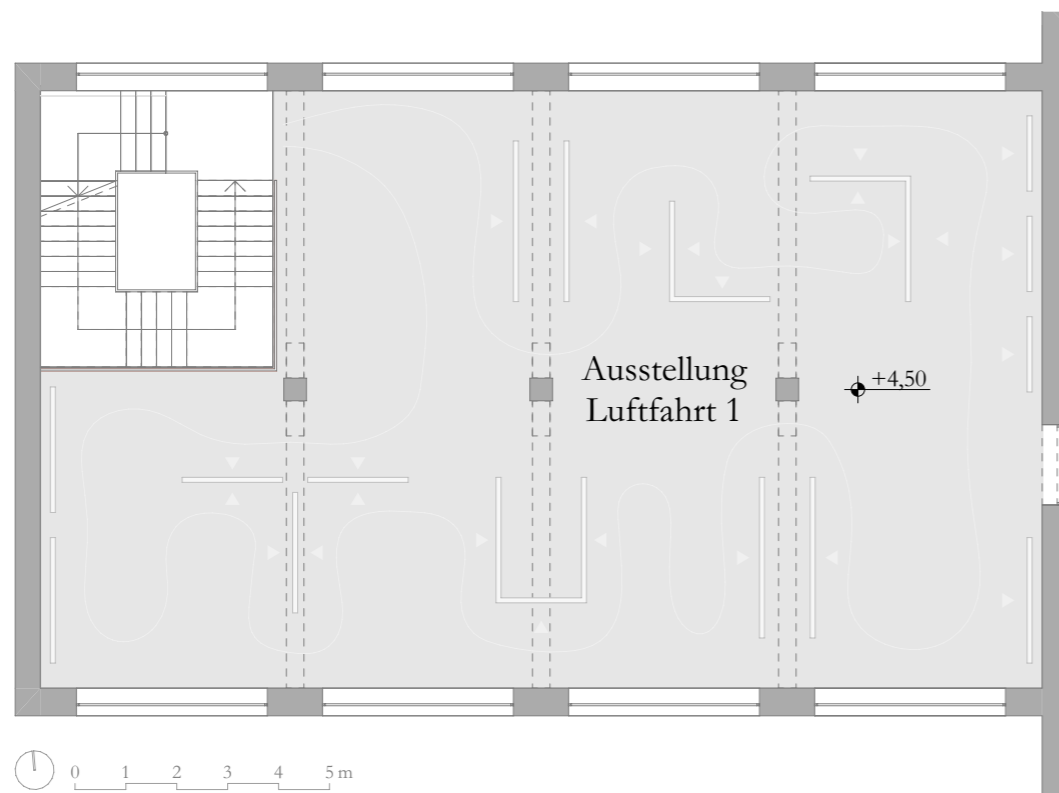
Grundriss Obergeschoss (Detail Ausstellung Luftfahrt) M 1:150
